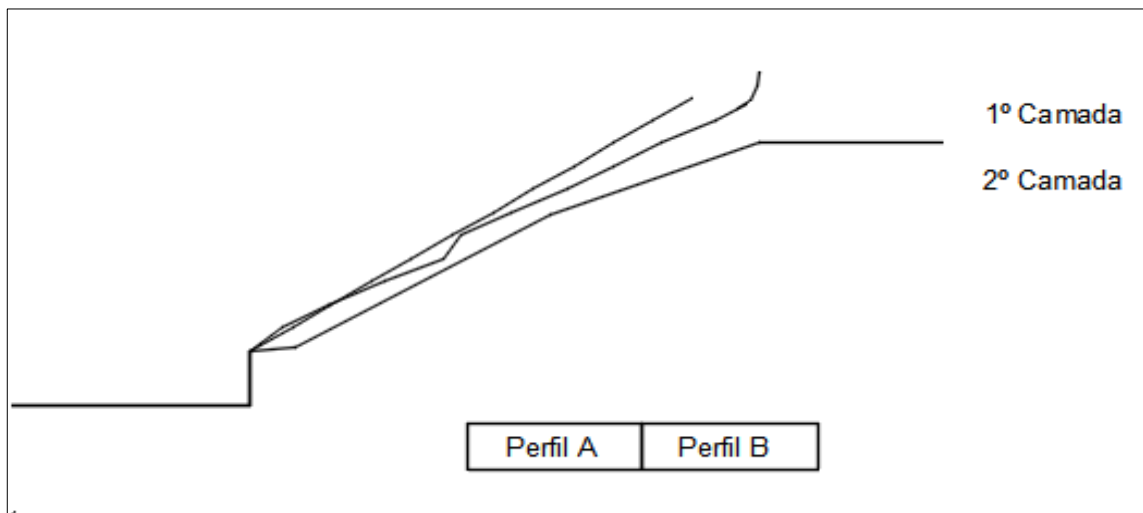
Perfil B com localização e dados da sondagem a trado
